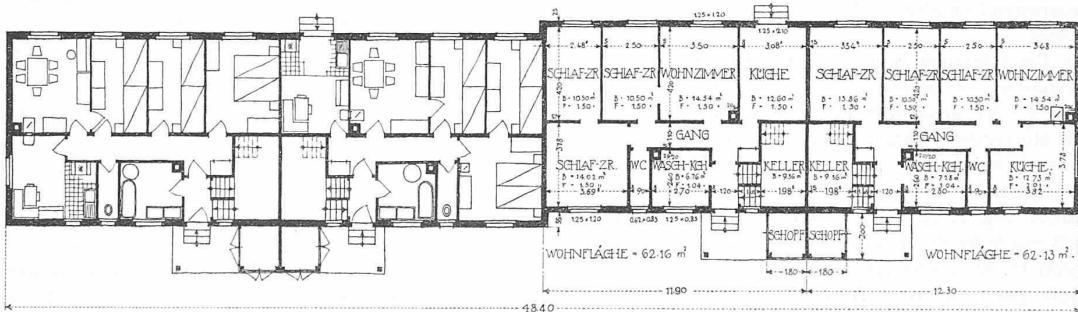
Grundriss zweier Doppelhäuser mit vier Vierzimmerwohnungen. — Masstab 1 : 300.
